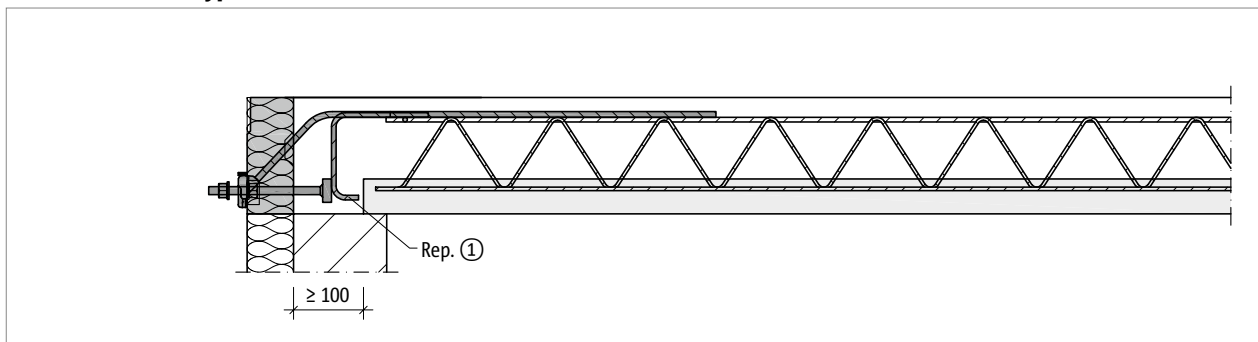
Schöck Isokorb® T type SQ : renforcement sur site pour construction semi-préfabriquée, coupe
